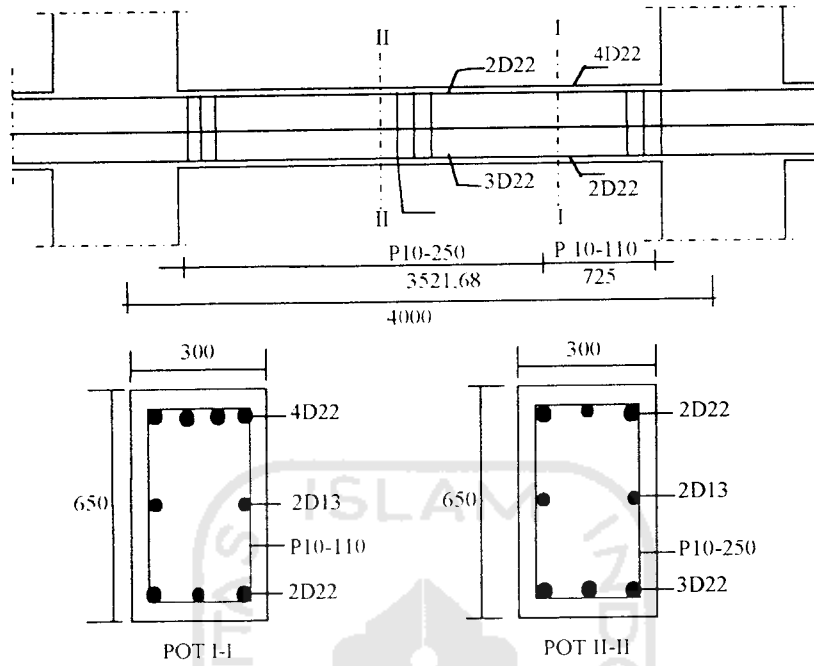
Balok Portal E Bentang 4 m Lantai 7
